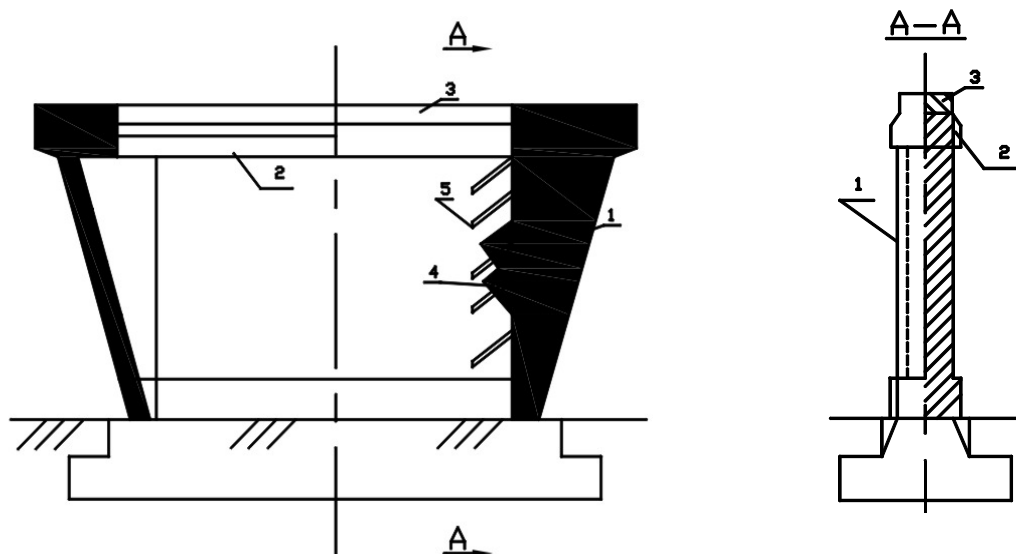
Уширение массивных опор пристройкой массивов монолитного железобетона: 1 – пристроенный массив; 2 – охватывающий пояс; 3 – оголовки опоры; 4 – штрабы; 5 – анкеры
